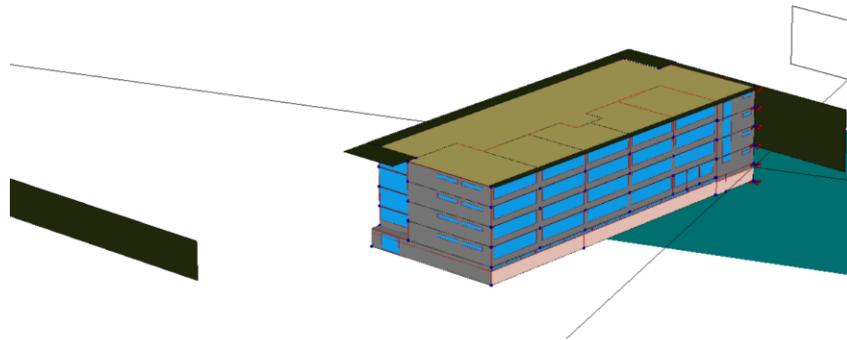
Modelo final en HULC visto por las fachadas oeste y norte.
